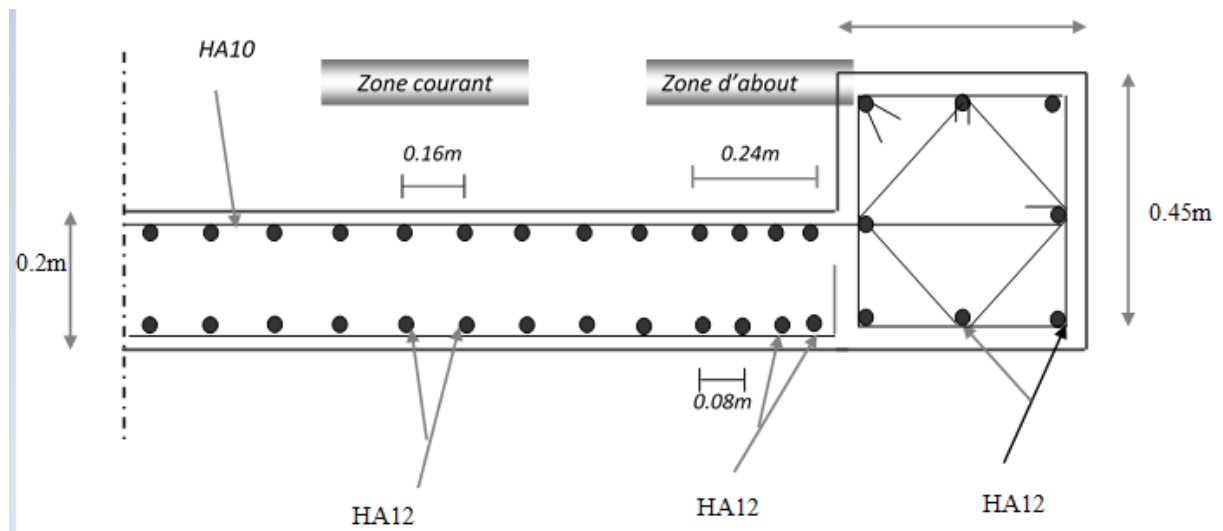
Dessin du ferrailage du voile de contreventement.
